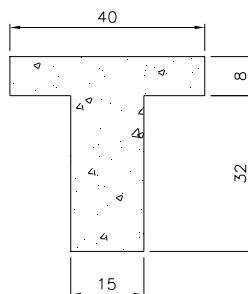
Seção transversal das vigas T (cotas em cm).
